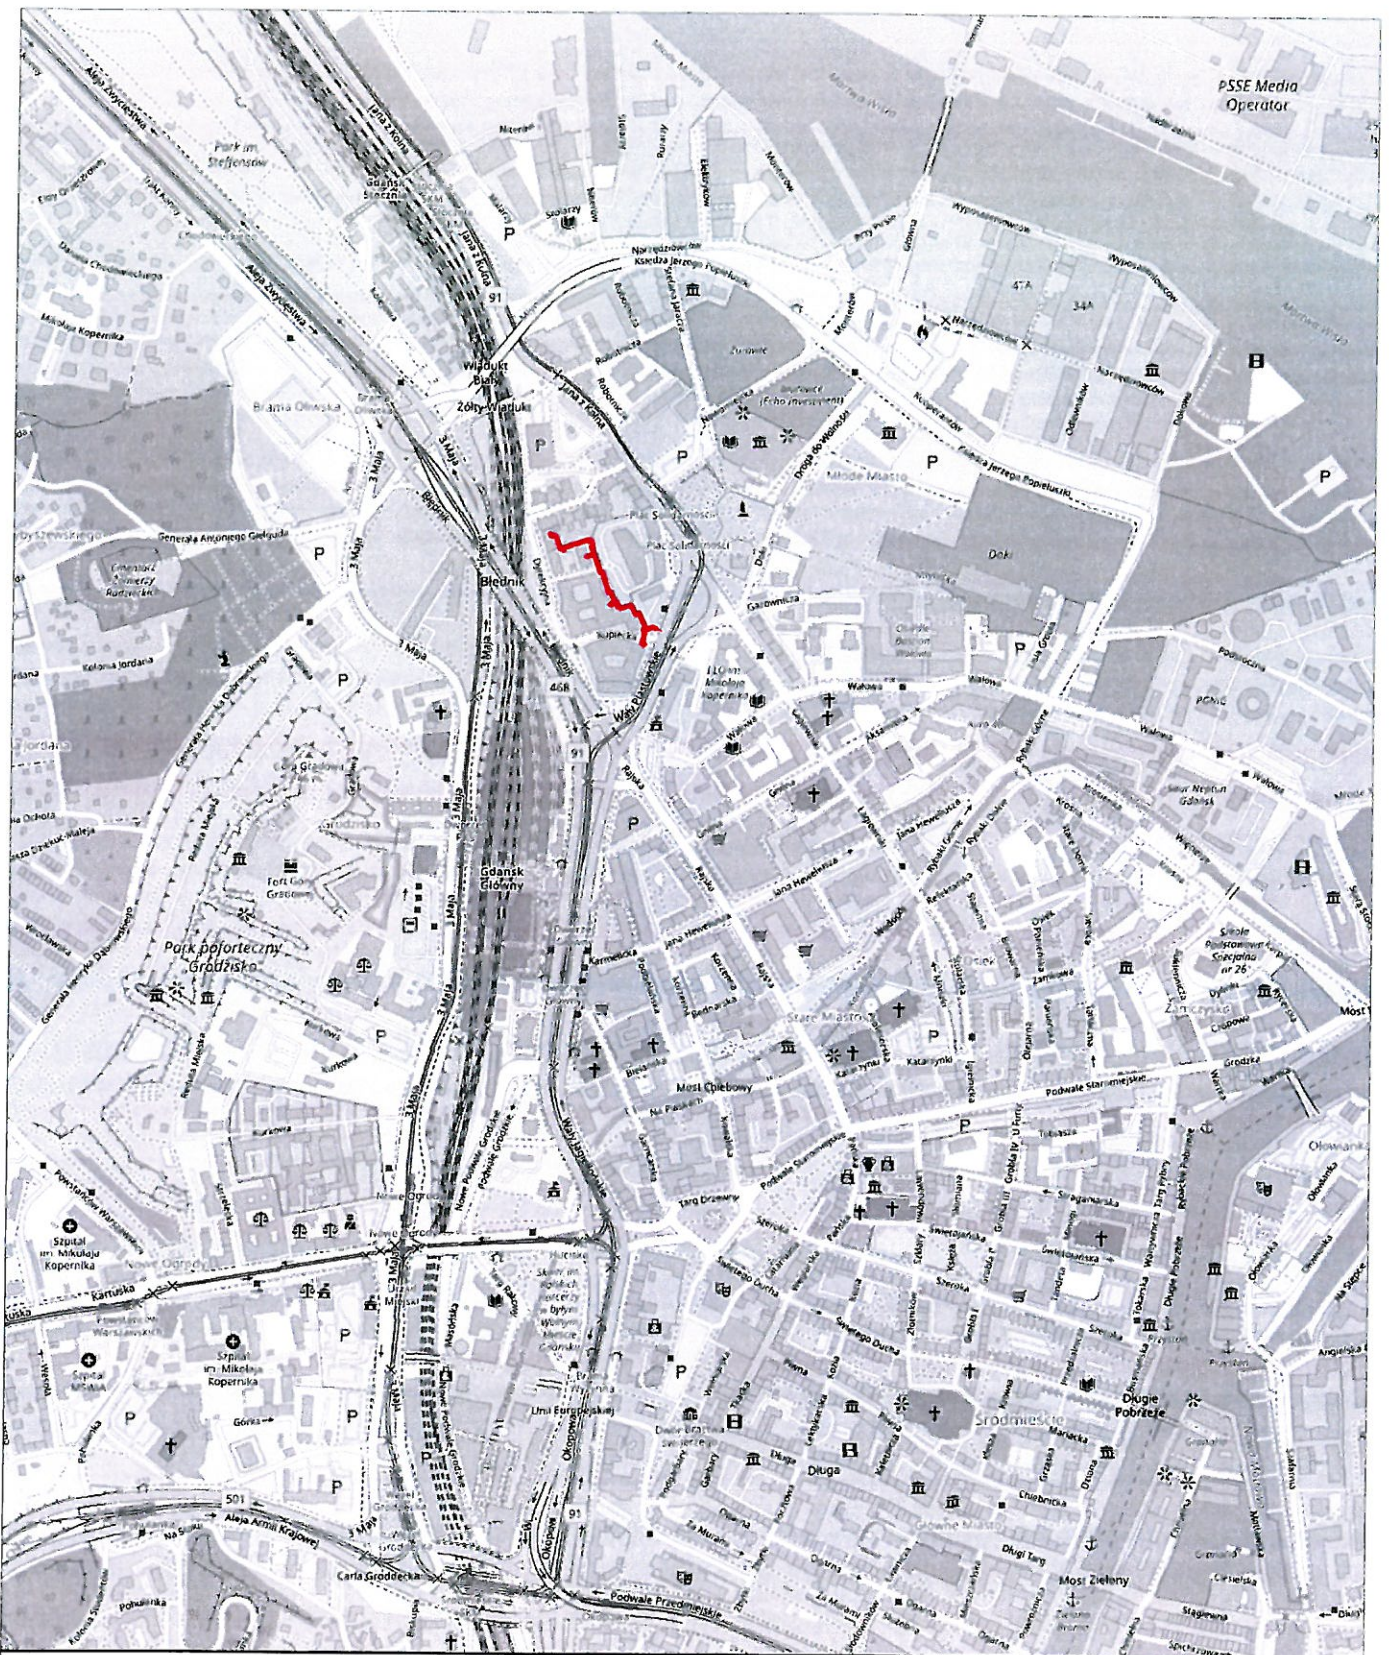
Ark. 3/7 – plan sytuacyjny: ETAP III
